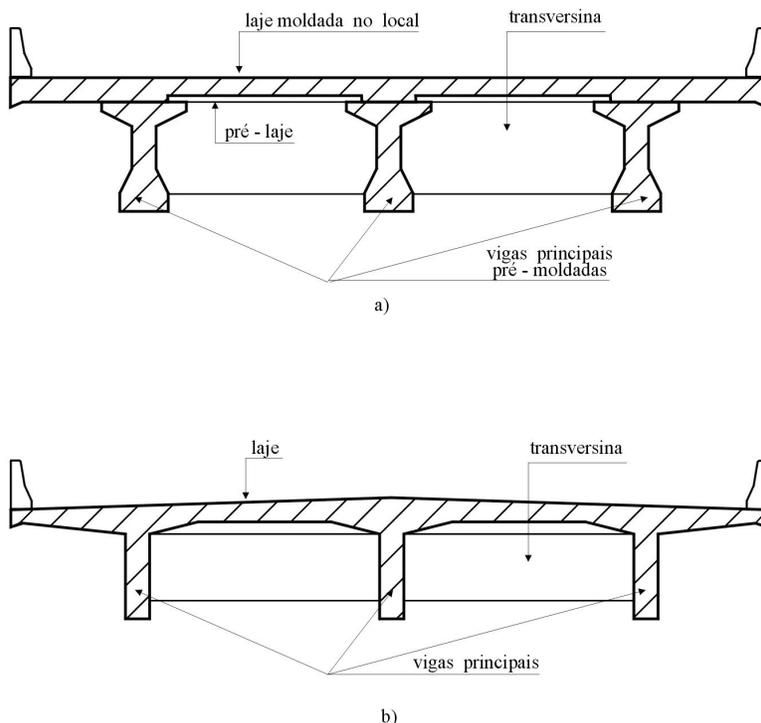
Lajes e vigas do tabuleiro de pontes: a) laje concretada no local sobre pré-lajes apoiadas em vigas pré-moldadas; b) laje em concreto armado apoiada nas vigas principais.
